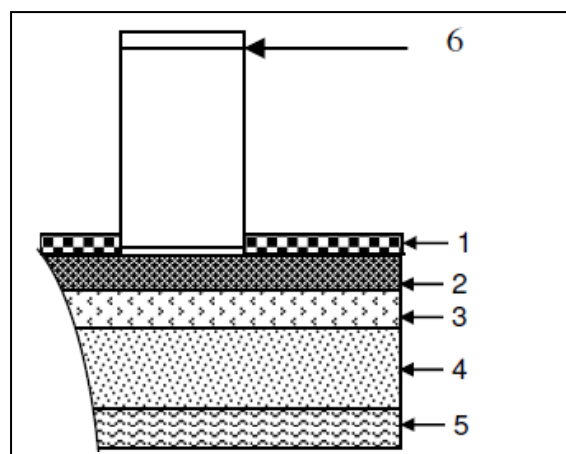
Charges permanentes du plancher courant à dalle pleine
